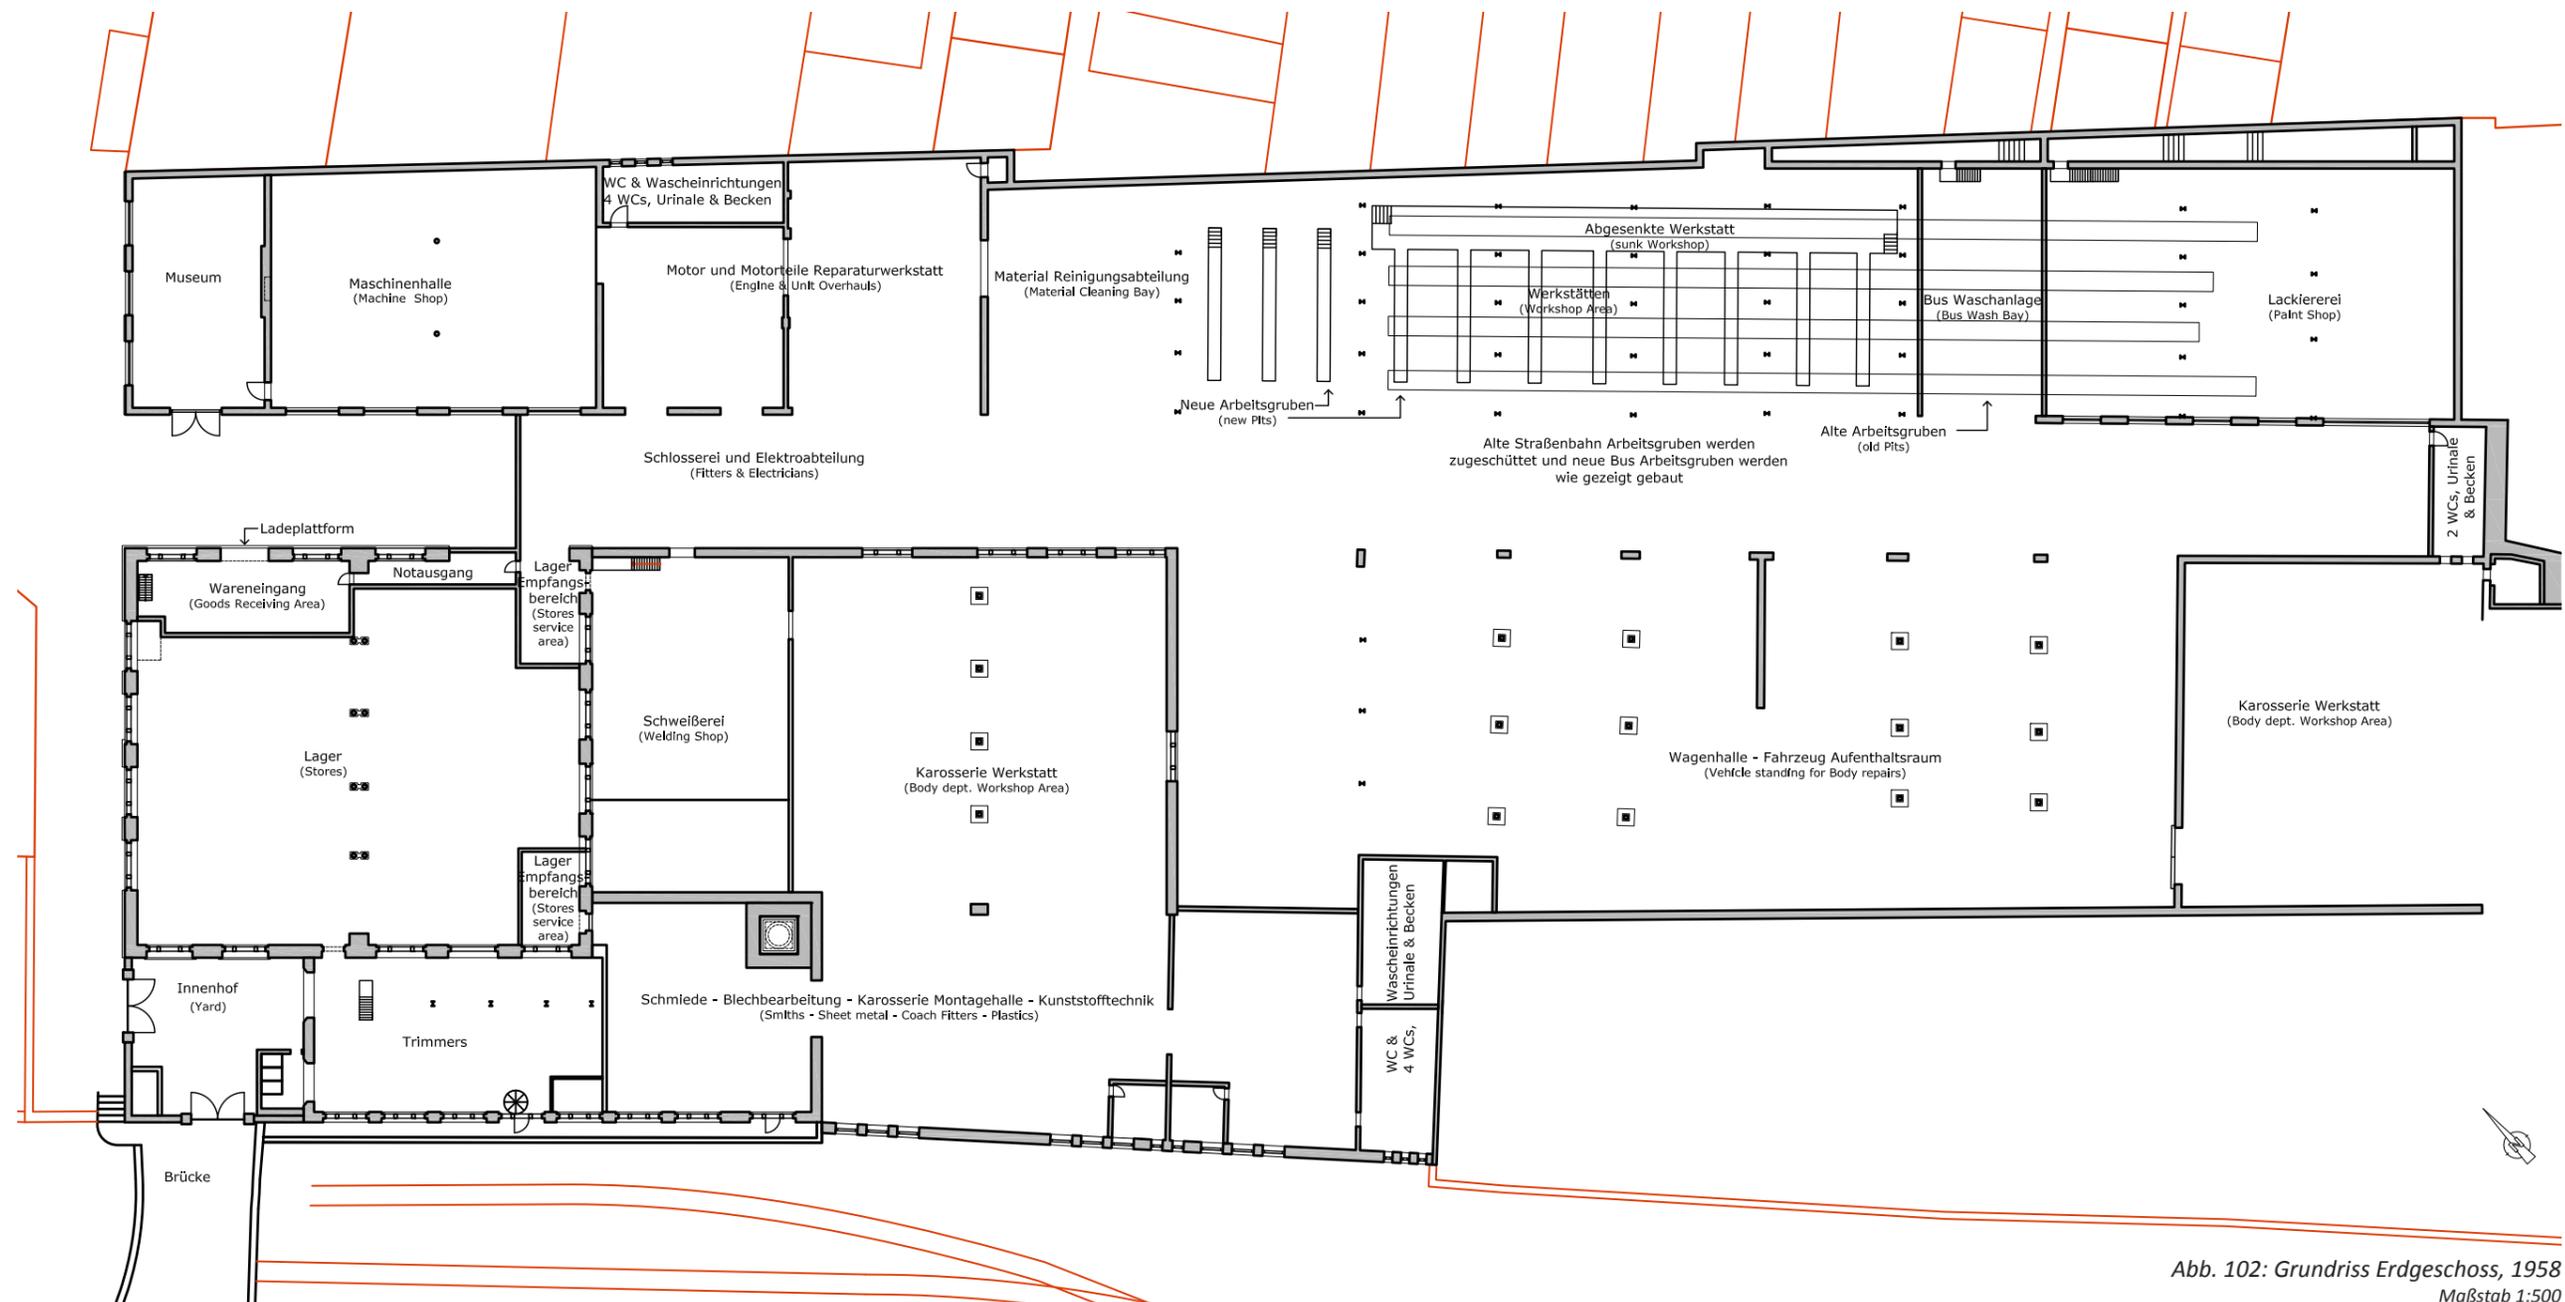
Grundriss Erdgeschoss, 1958
